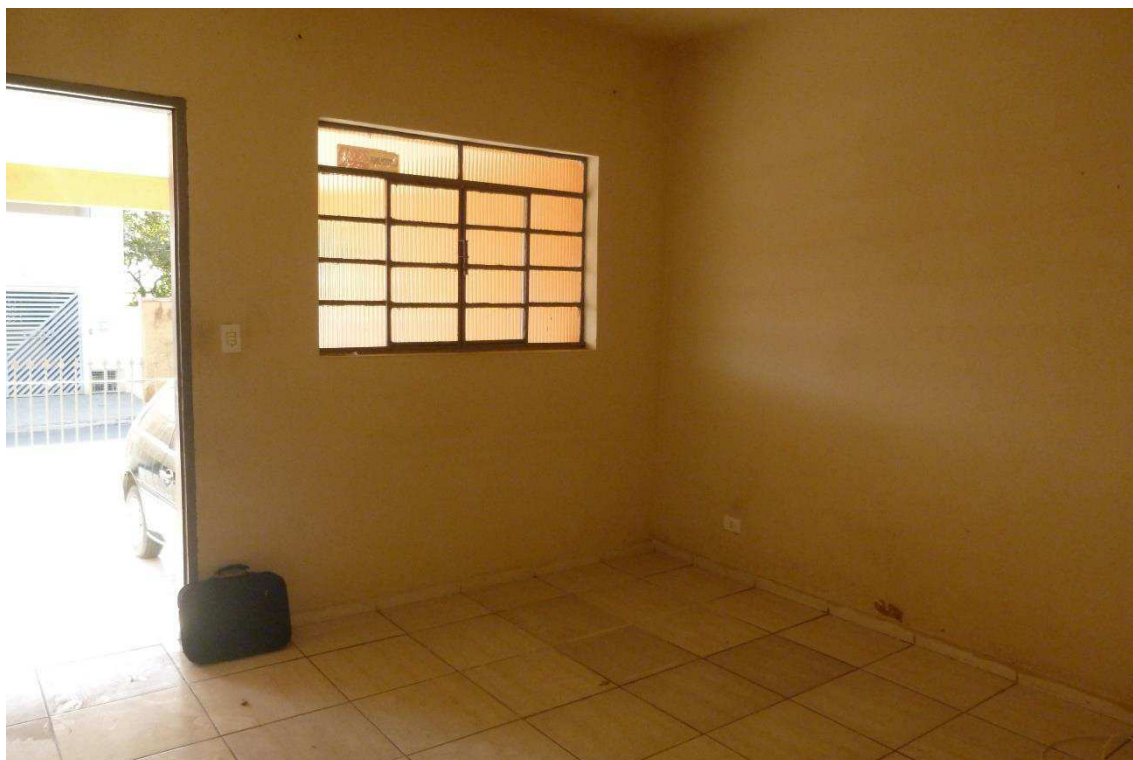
Vista da sala com laje de forro, piso cerâmico comercial e pintura em razoável estado de conservação.
